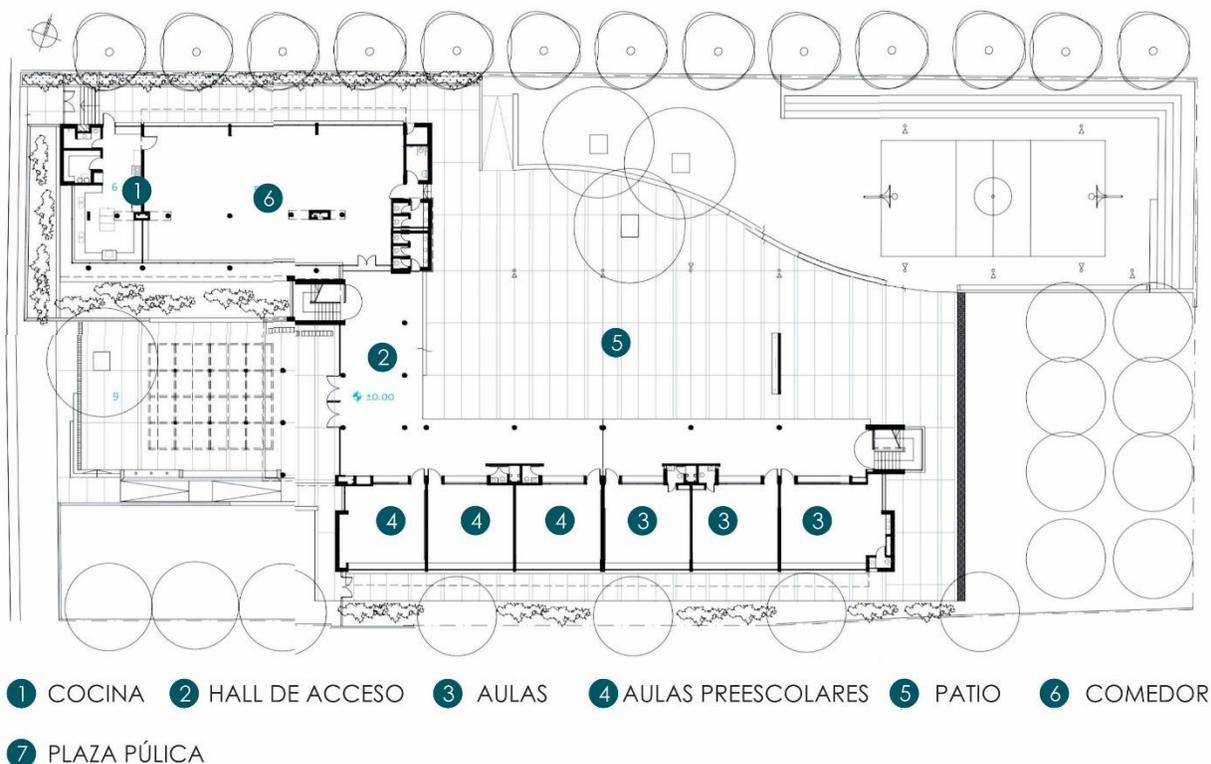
Imagen del plano arquitectónico de la ETC N° 291. (MECAEP, s.f.)
